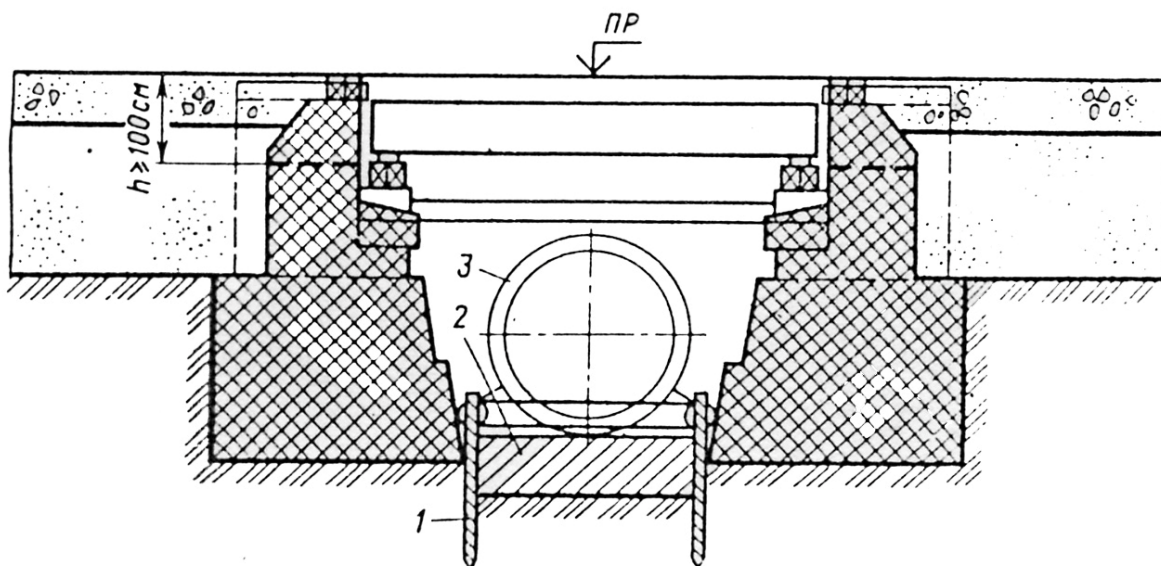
Переустройство малого балочного железобетонного моста в одноочковую железобетонную трубу:
